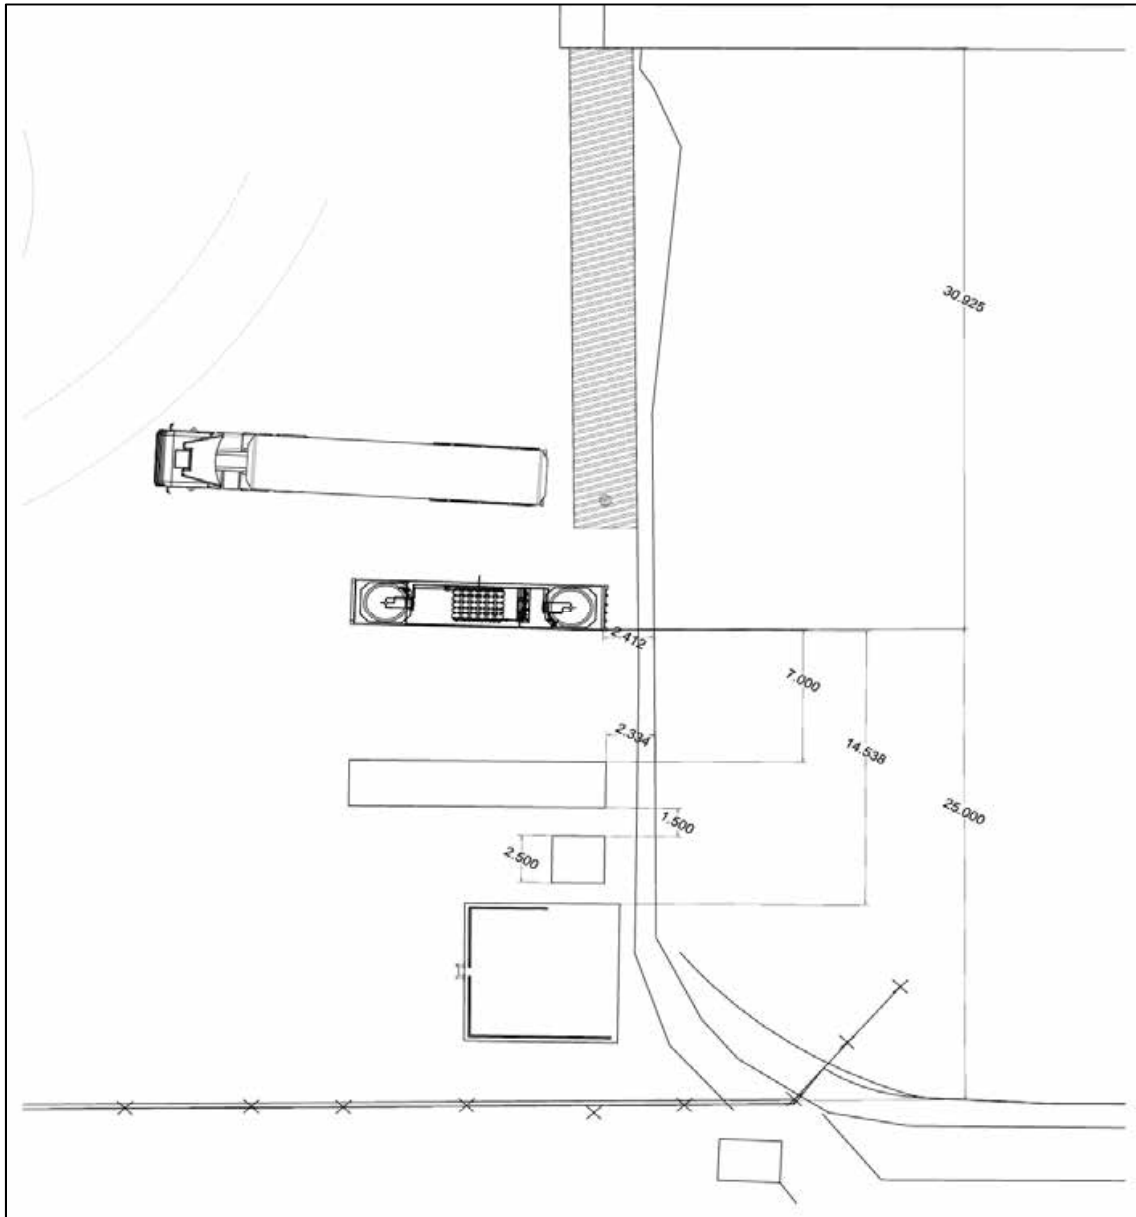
Distribución en planta de los elementos. Fuente: Elaboración propia.
